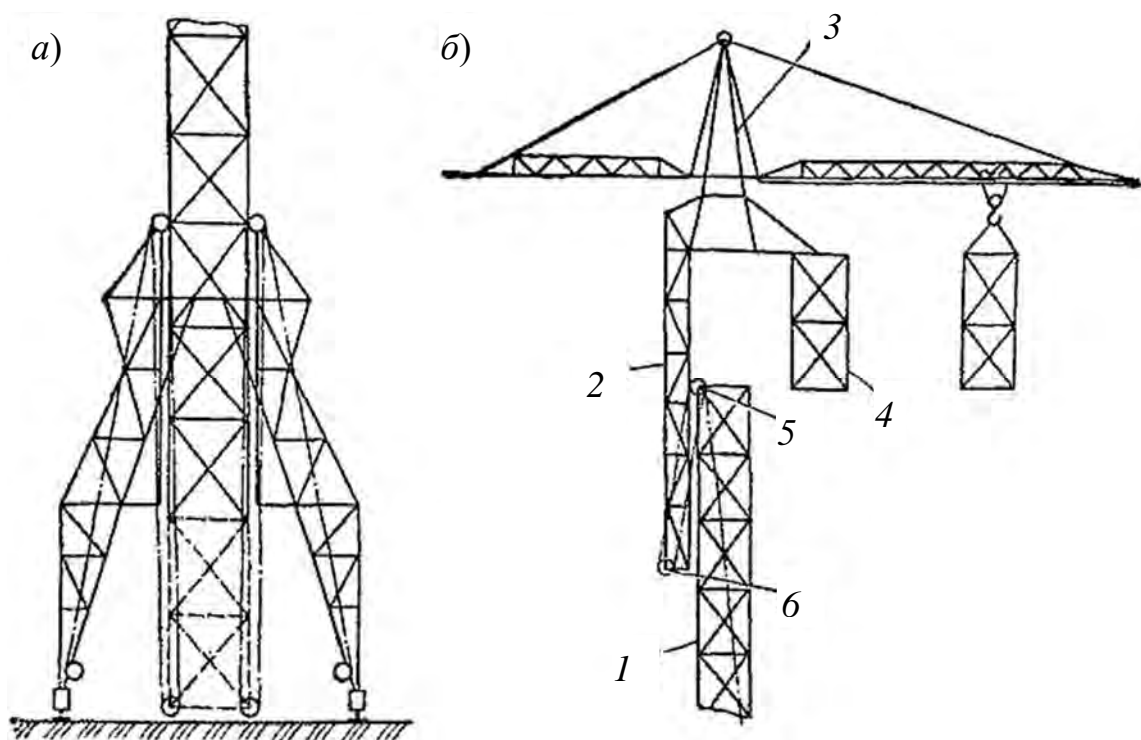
Схемы наращивания башен: *a* – снизу; *b* – сверху; 1 – башня; 2 – ферма; 3 – оголовок («колокол») башни; 4 – новая секция башни; 5 – подъемные блоки; 6 – блоки фермы
